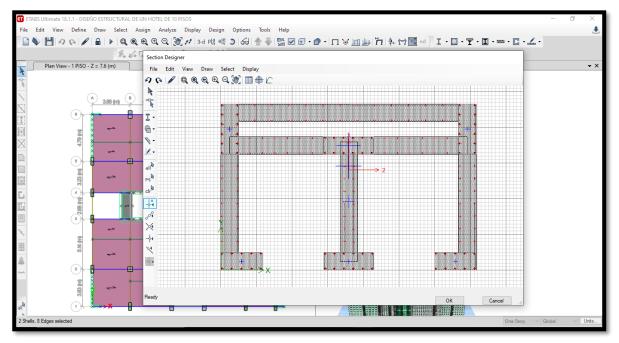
Vista en planta del armado de acero en la sección del ascensor: PL - 2.
